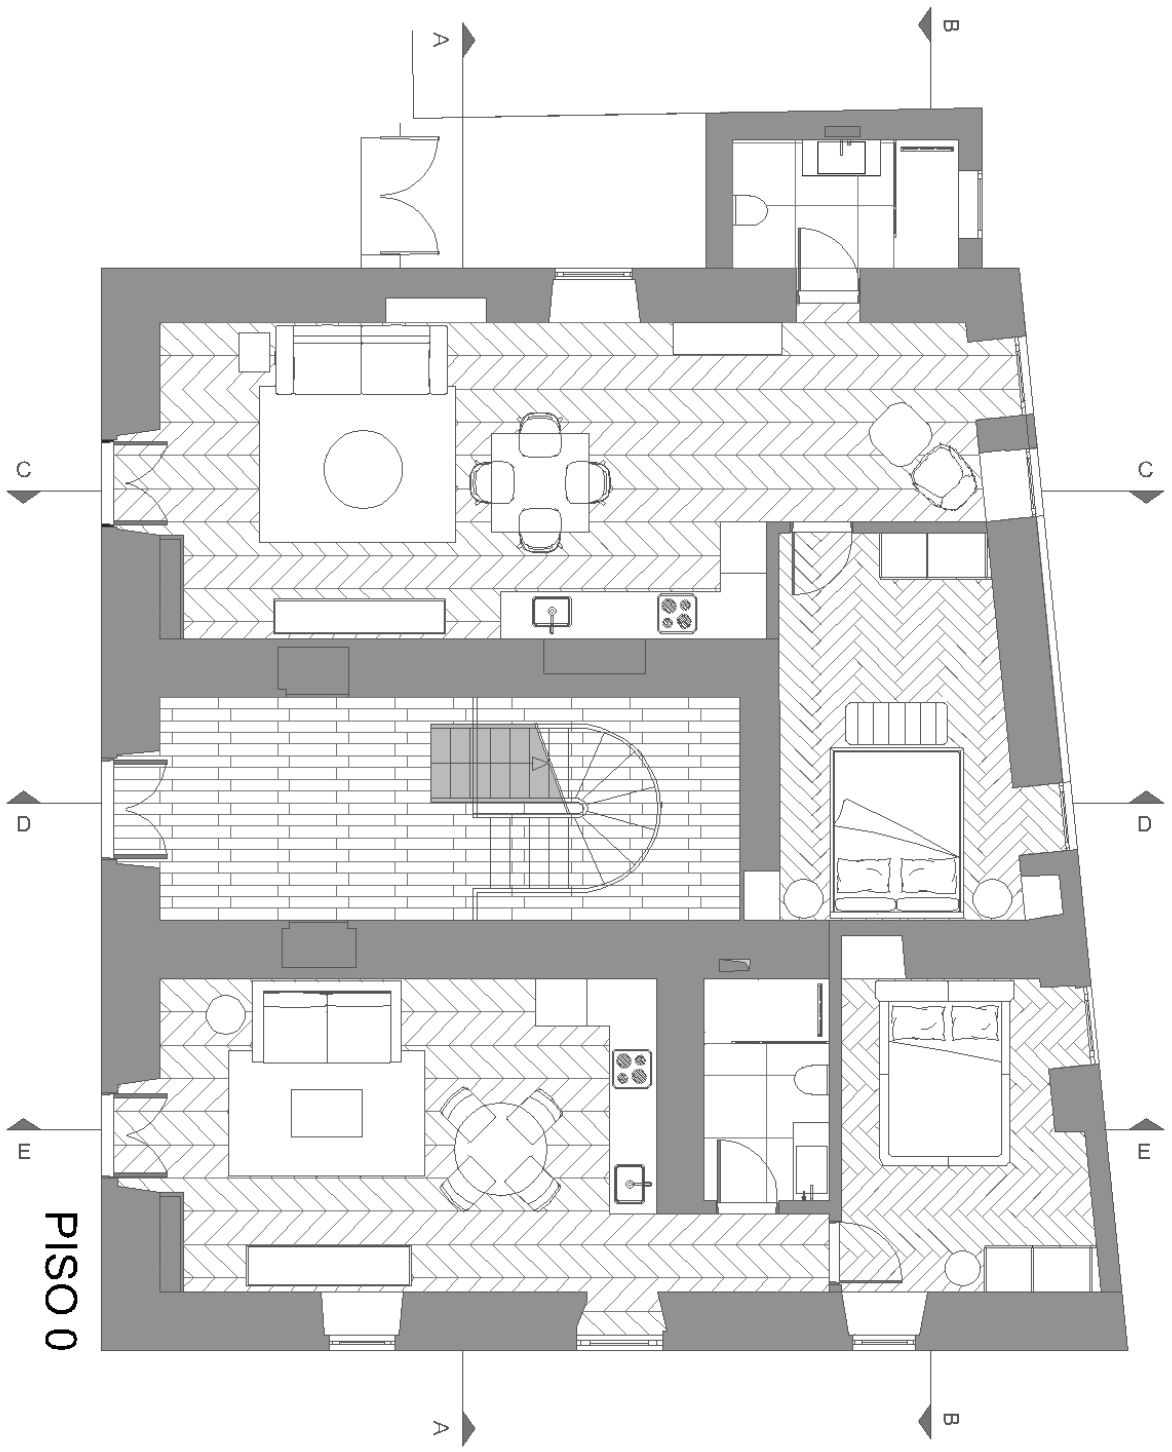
Planta do piso 0 com identificação dos cortes (Não está escala)
